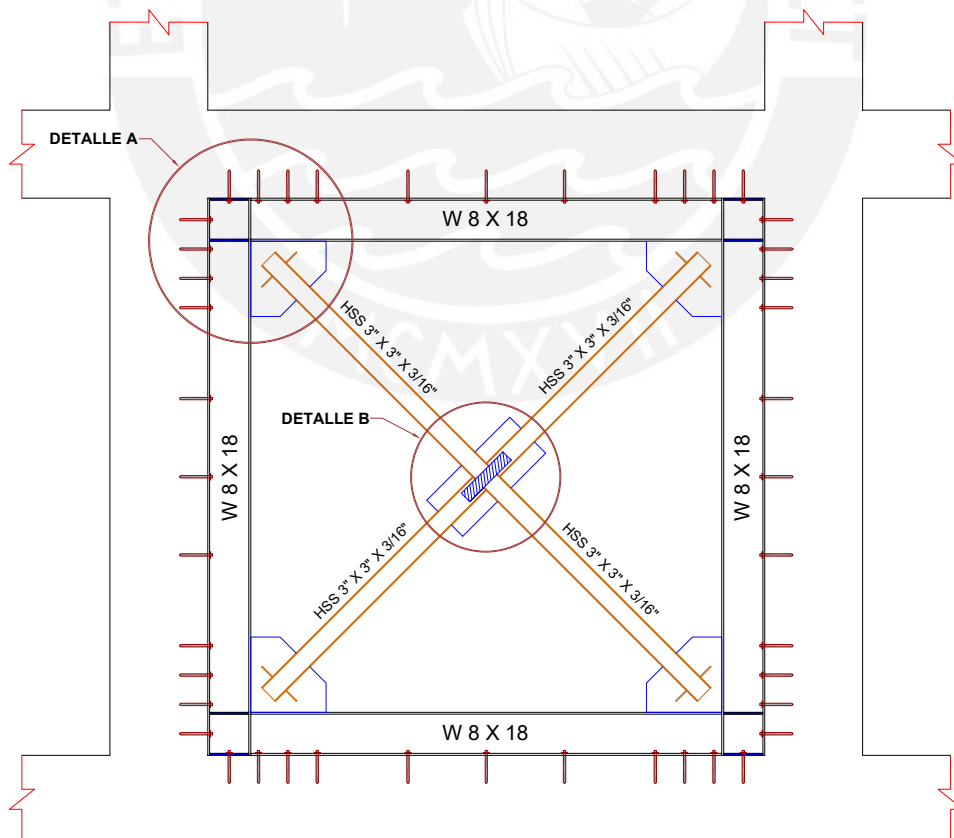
Refuerzo ubicado dentro de un pórtico de concreto armado
